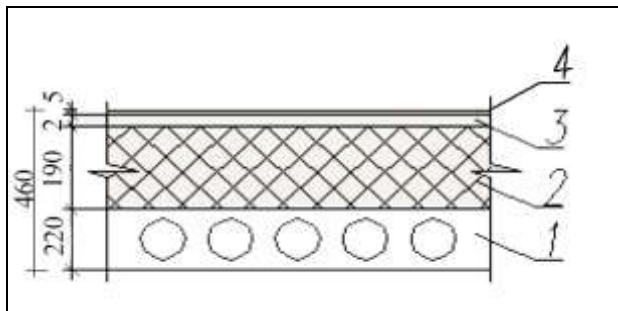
Перекрытие над неотапливаемым подвалом.
